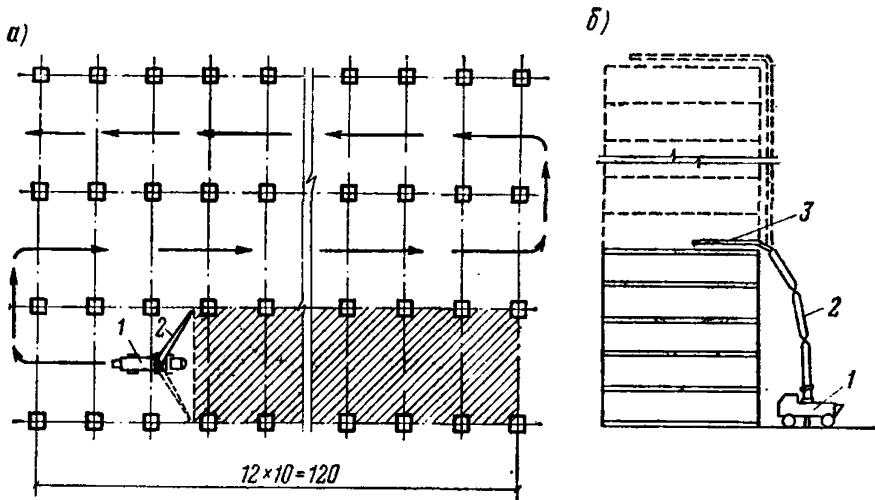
Схема бетонирования полов и перекрытий одноэтажных (а) и многоэтажных (б) зданий автобетононасосом с распределительной стрелой
